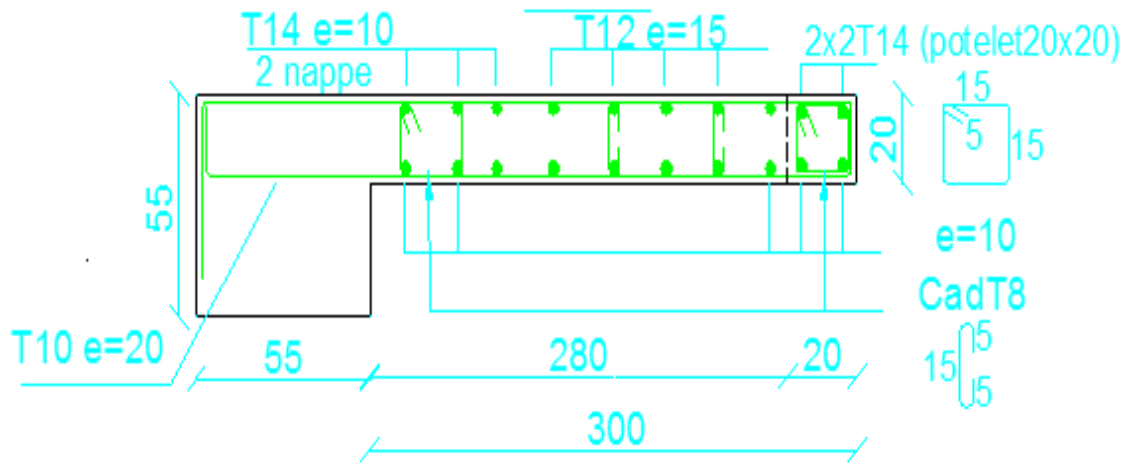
Schéma de ferrailage des voiles type V9 zone 1.
